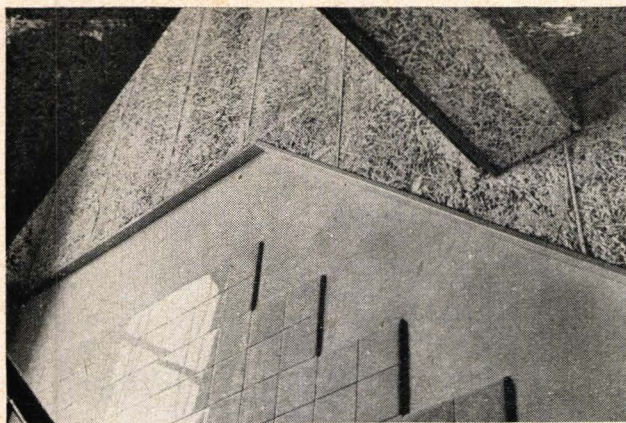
Trappenhuis, gedeeltelijk bekleed met wit gekleurde houtwol-cement platen.
